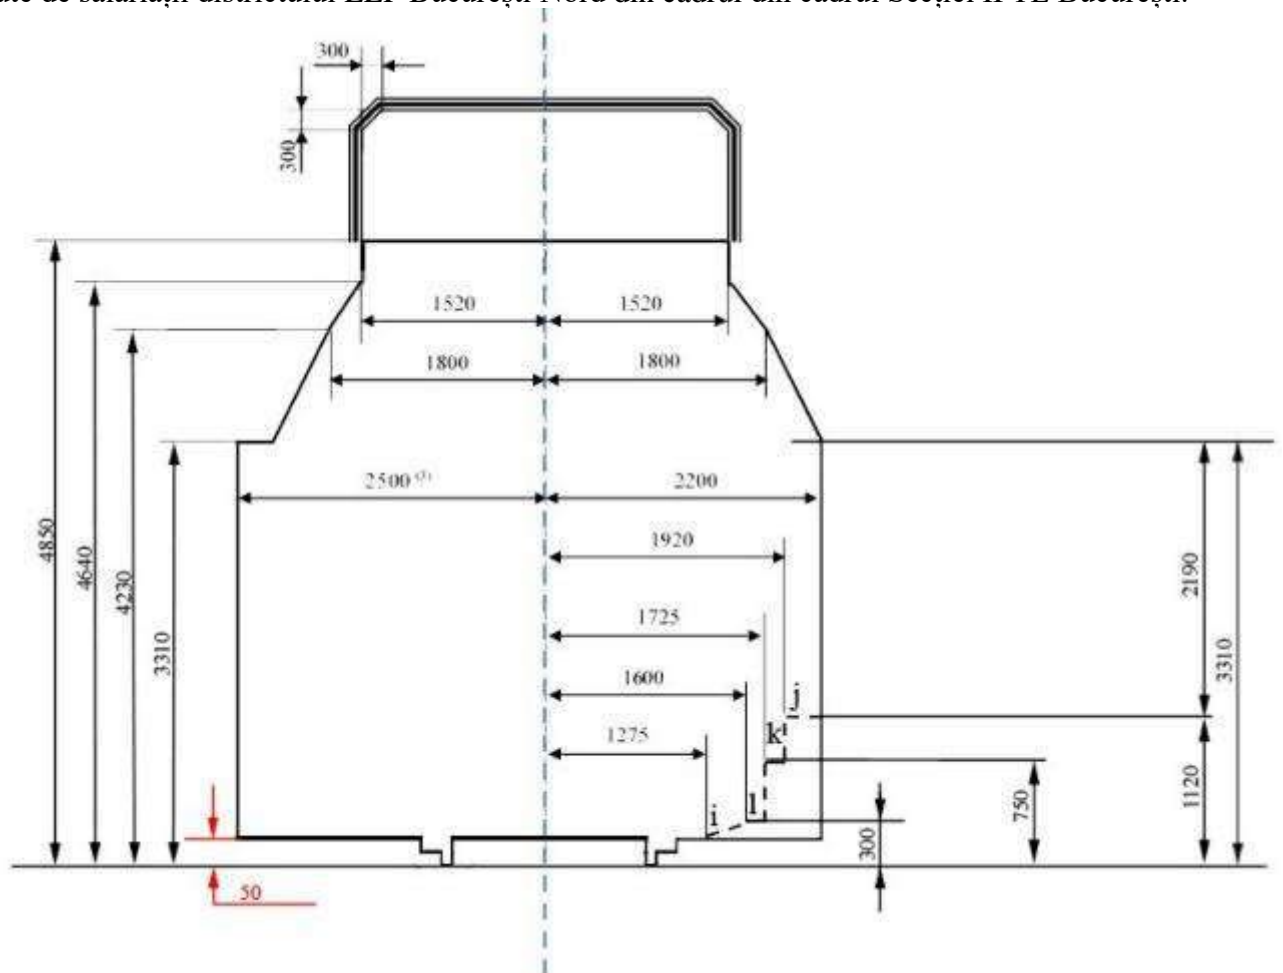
Gabaritul CFR pentru elementele instalațiilor feroviare
